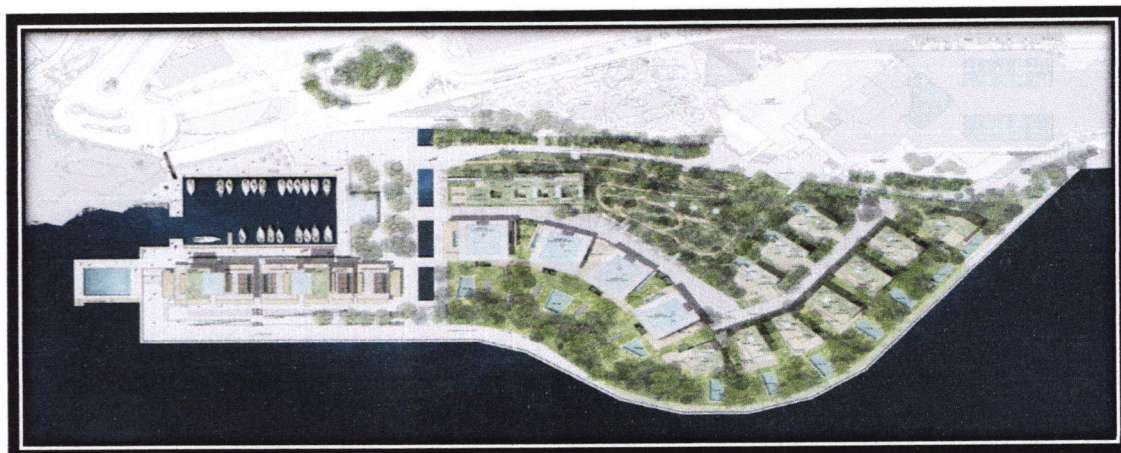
Le plan masse de la nouvelle extension de Monaco
